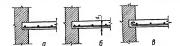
Анкеровка сварных сеток на свободных опорах плит; α — крайний монтажный стержень расположен за гранью опоры; δ — дополнительный монтажный стержень приварен к концам рабочих стержией; α — на концах рабочих стержией стех устраиваются крюки.
